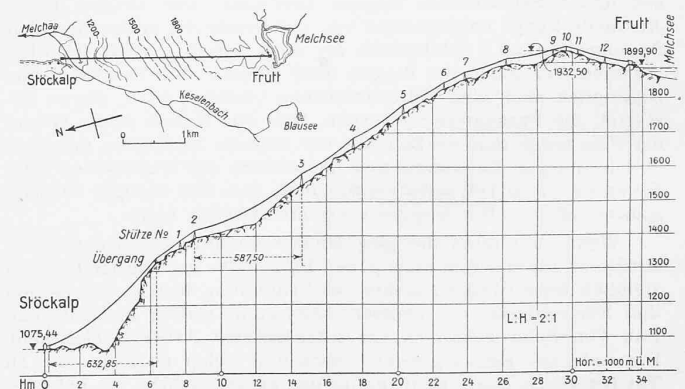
(oben) Lageplan, Abb. 5 Längenprofil Stöckalp-Frutt (Melchsee).
